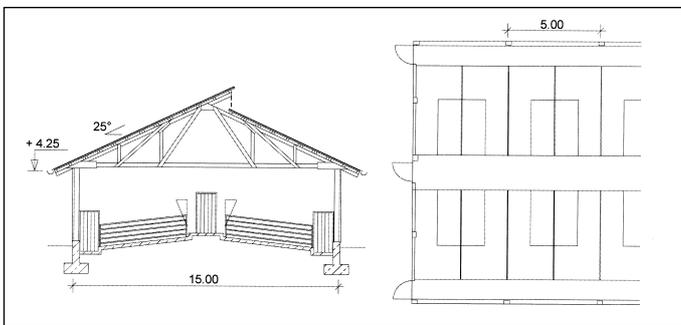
Schnitt und Grundriss von Mastschweinen auf Schrägboden
